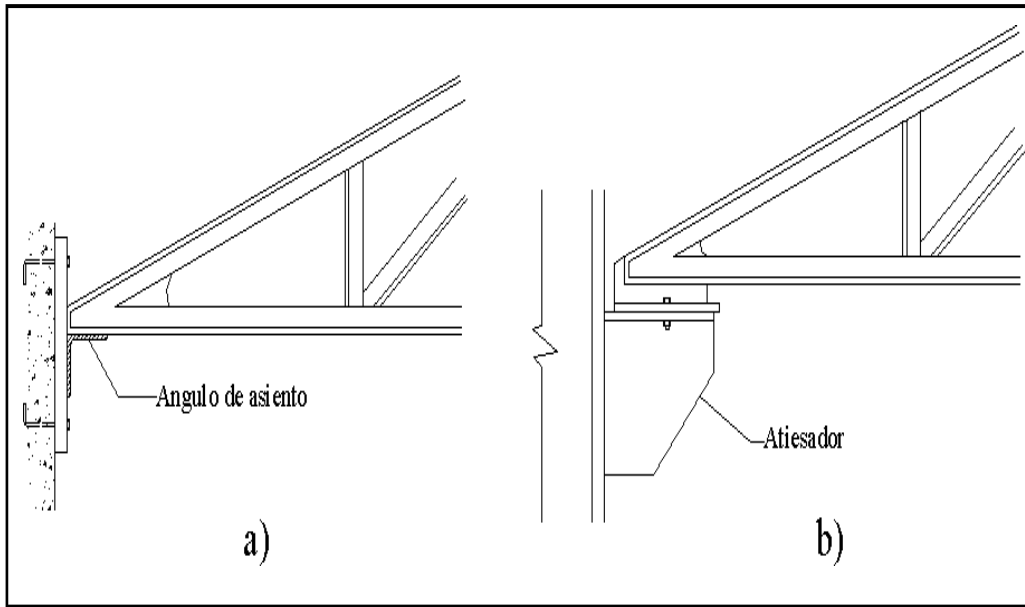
Apoyos No Atiesado y Apoyo Atiesado
